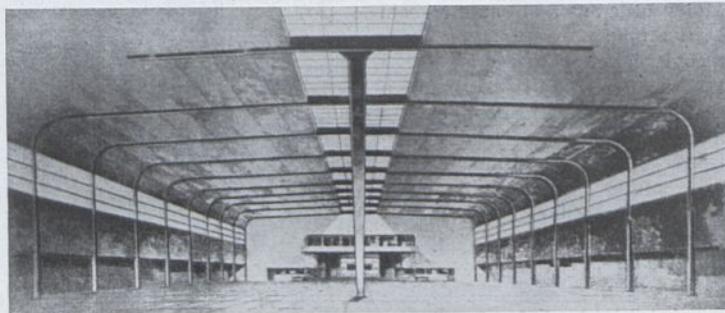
Entwurf für Messehalle XIX, Leipzig.
